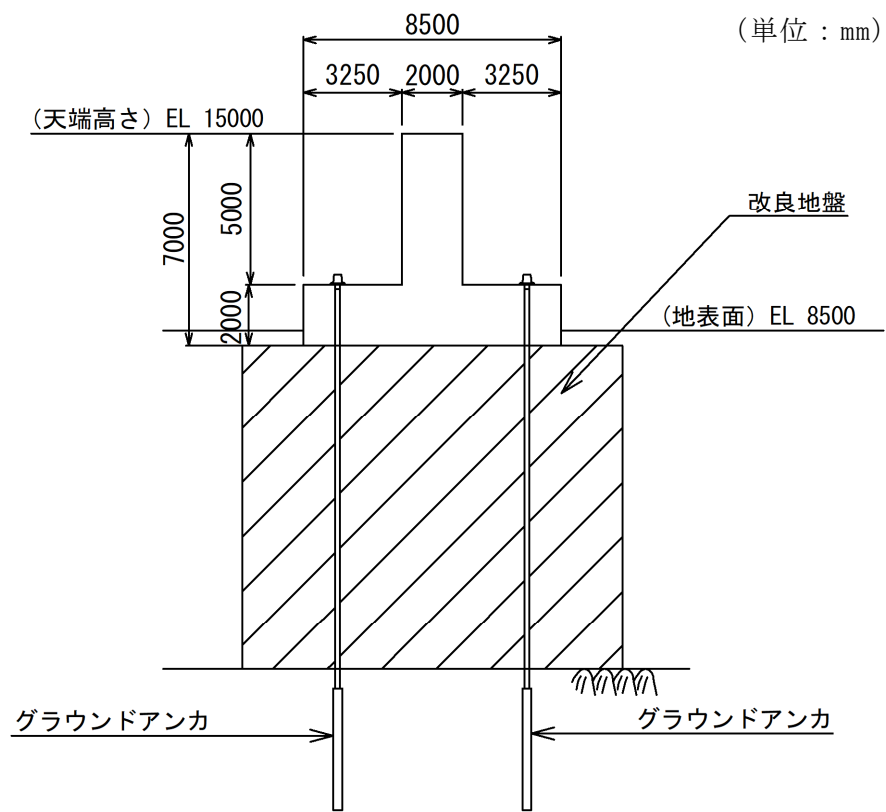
防波壁 (逆 T 擁壁) の構造図 (断面図)
